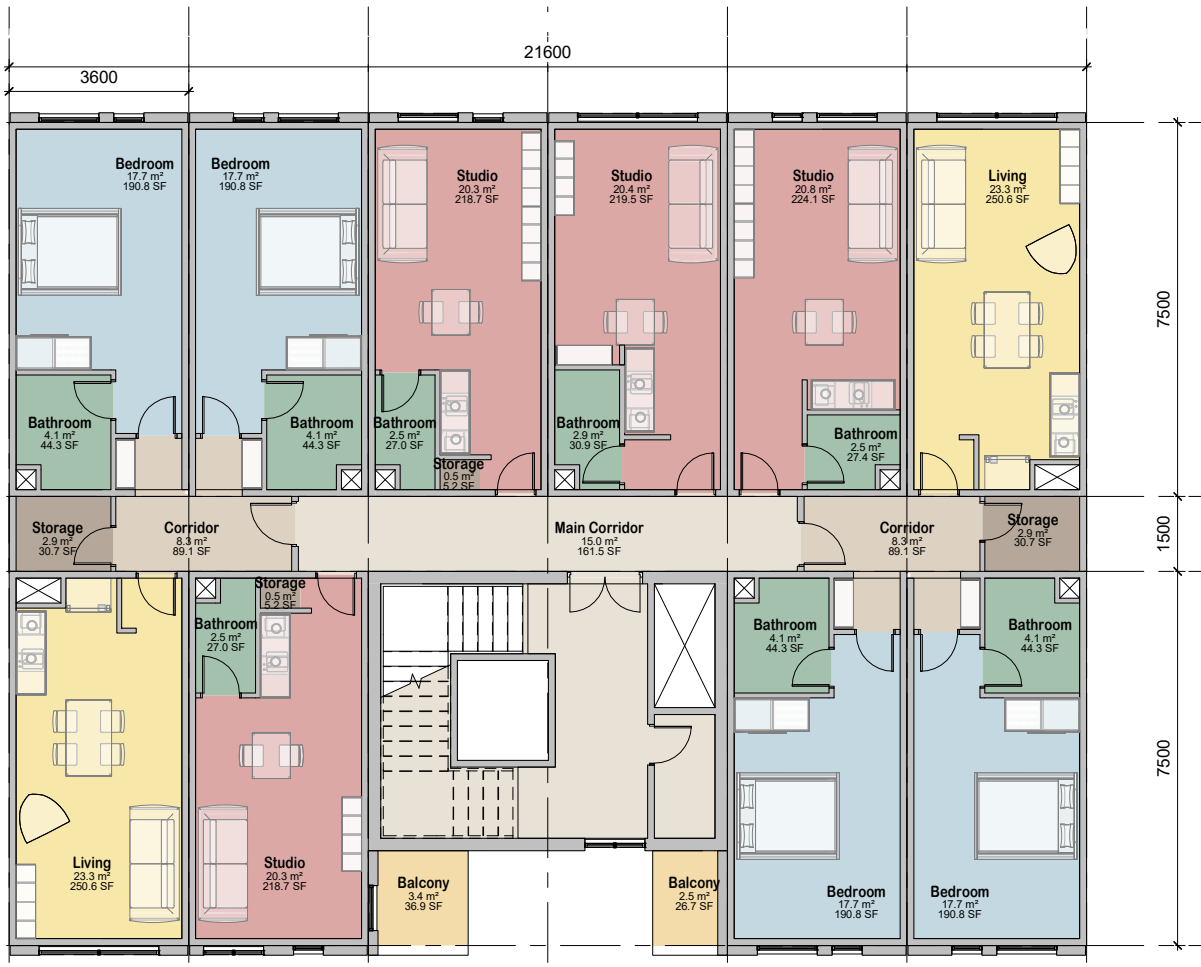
Концептуальний план будівлі для ущільнювальної забудови № 1 _ План поверху / поза масштабом
